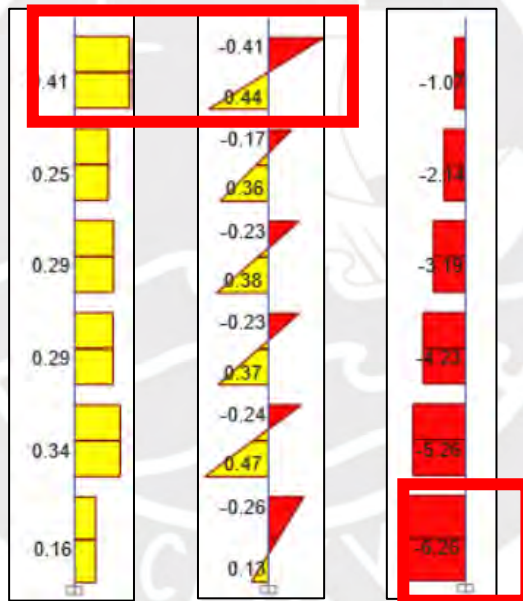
DFC, DMF y DFN respectivamente de columna C5 en pórtico 1-9 por carga viva
